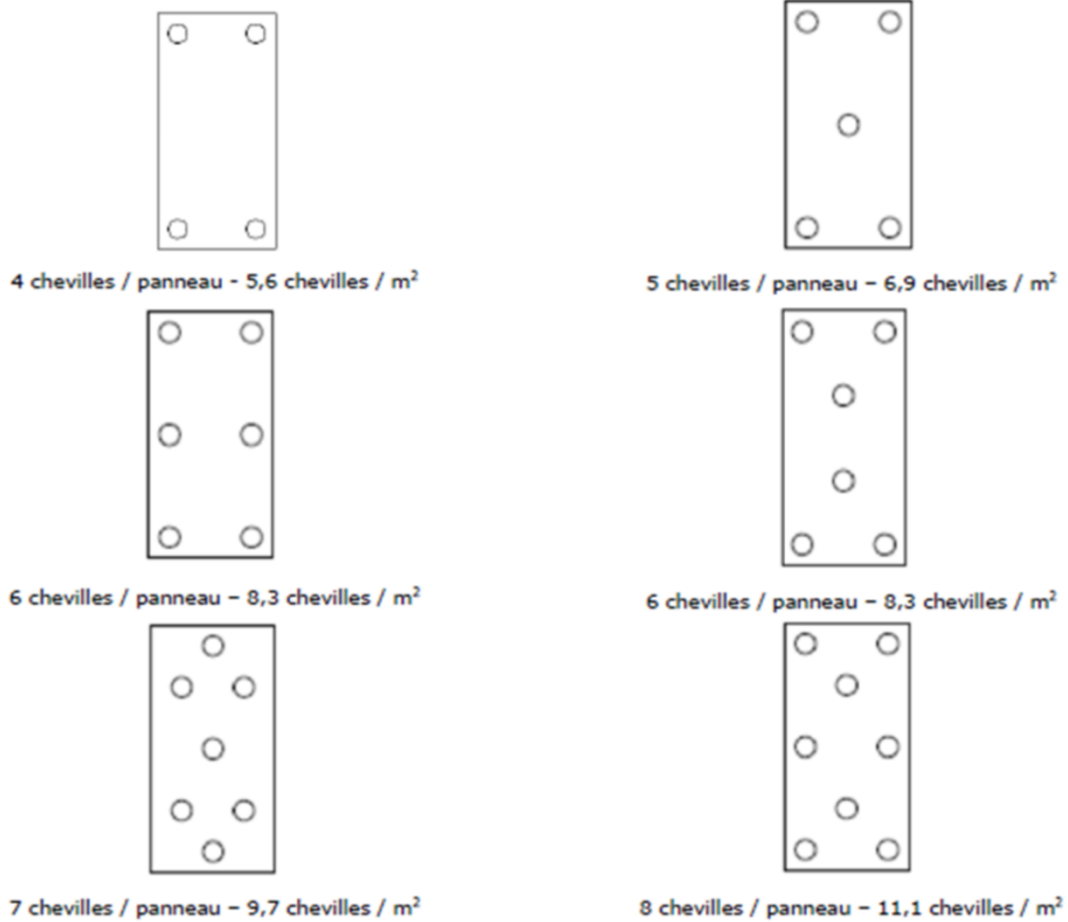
Exemple de plans de chevillage en pose verticale - panneaux de dimensions 1200 x 600 mm
